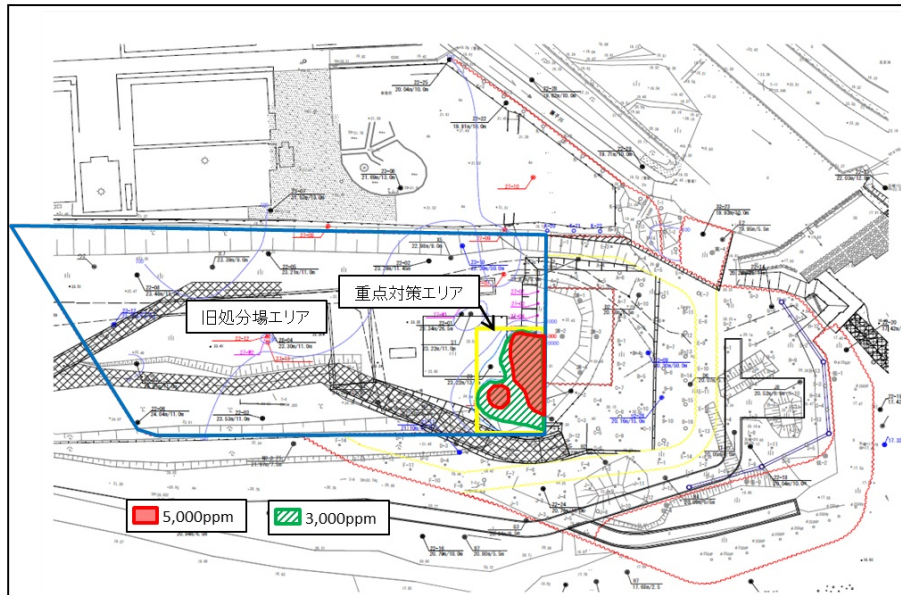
PCB 高濃度範囲（重点対策エリア）の設定
